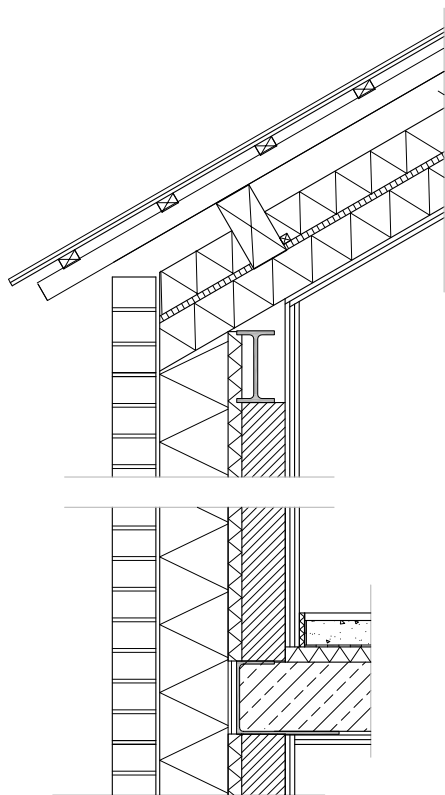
Schnitt Steildach mit Dachüberstand, M. 1:20
